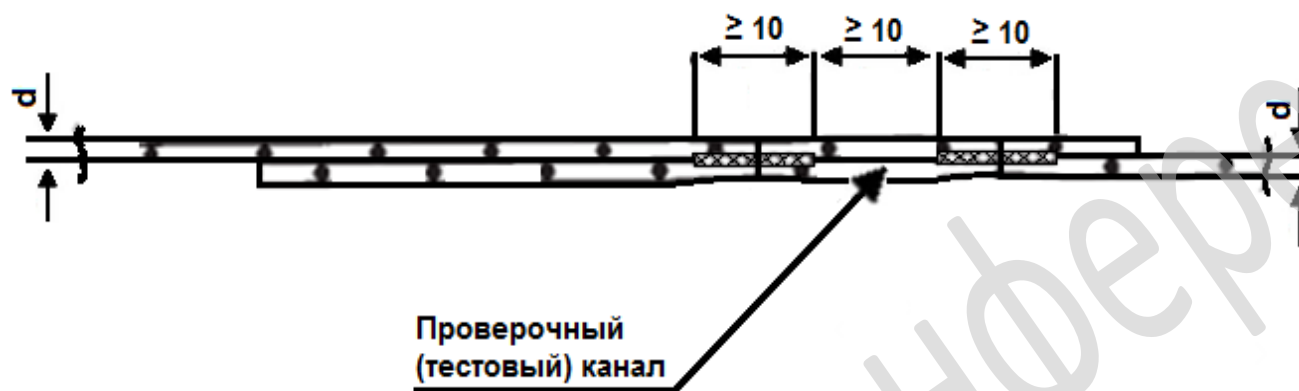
Сварное соединения с проверочным каналом (используется в основном для длинномерных швов).
